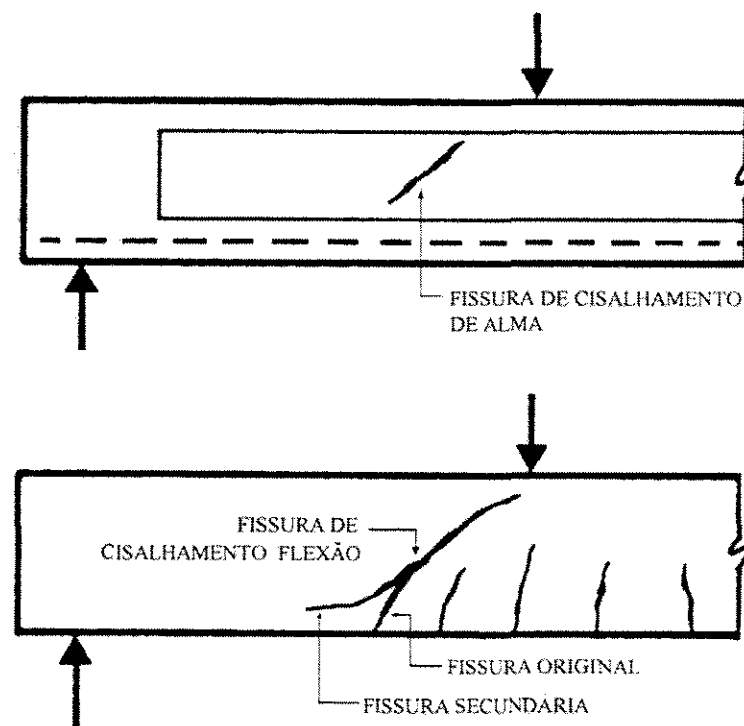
TIPOS DE FISSURAS INCLINADAS
